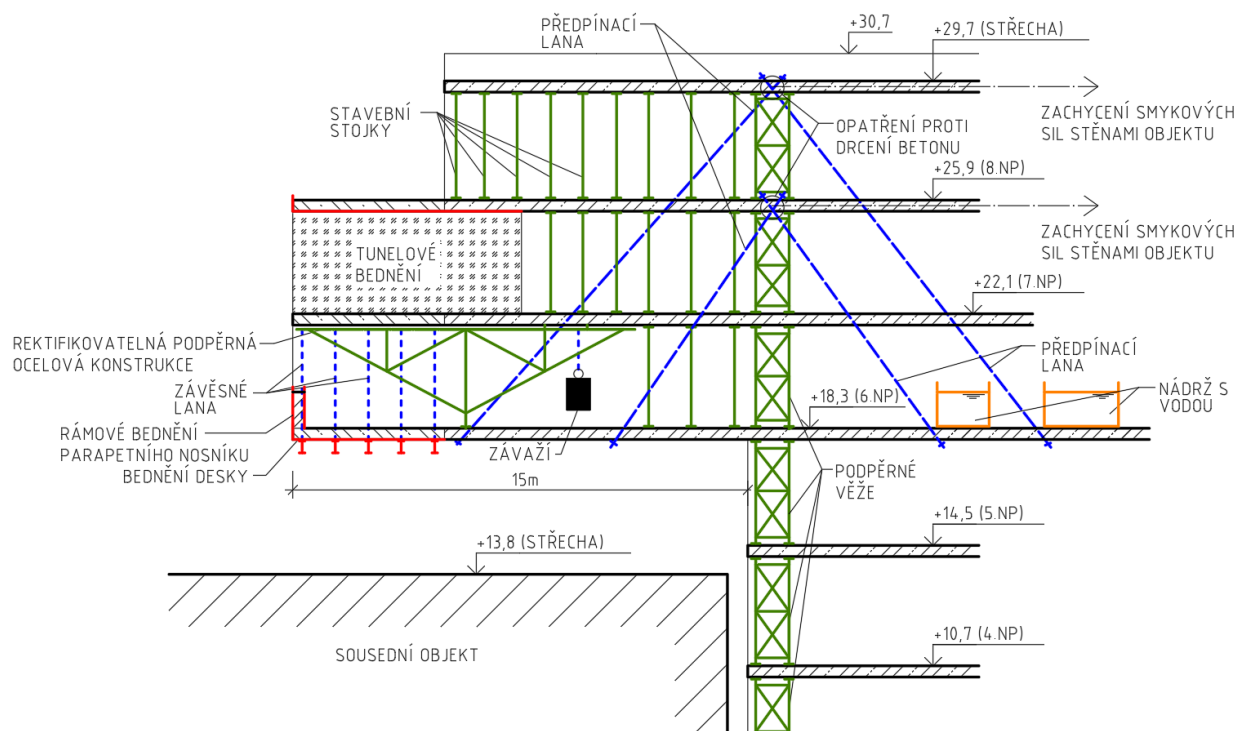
Schéma betonování spodní desky 7. záběru výstavby vyložené konstrukce
